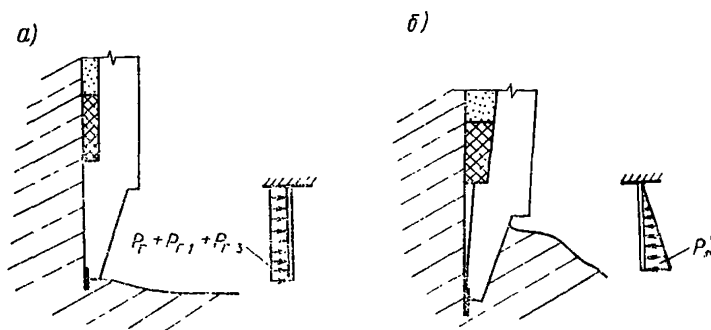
(8). Схемы положения железобетонной консоли ножа колодца при погружении колодца и соответствующие расчетные схемы а — при разработке грунта у ножа; б — при крене колодца; p'_r — пассивное давление грунта [(обозначение нагрузок в табл. 2.1 (3))]
